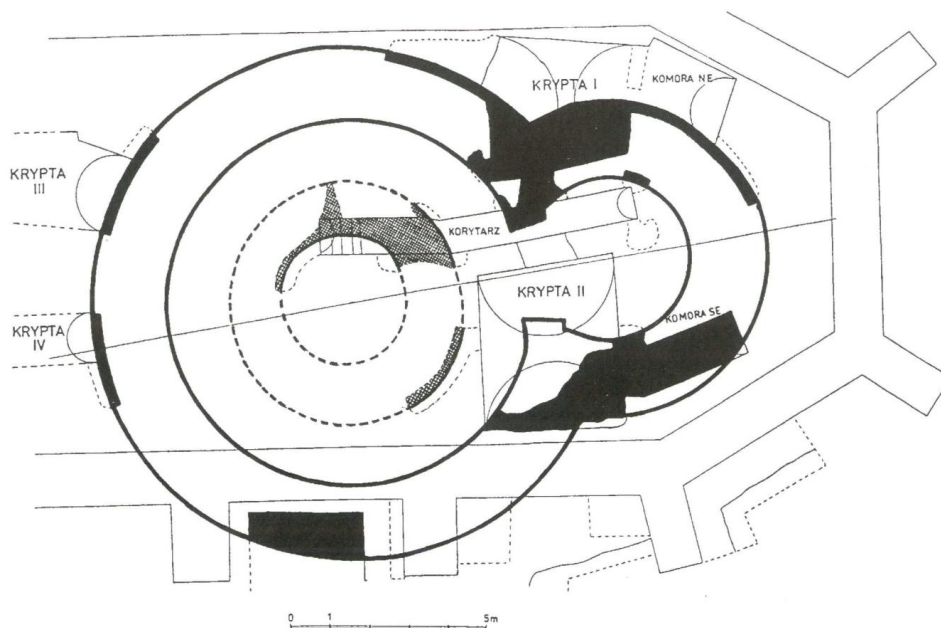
Przemyśl – rotunda św. Mikołaja, plan R. Halickiego (wersja uproszczona), za Z. Pianowski i M. Proksa
